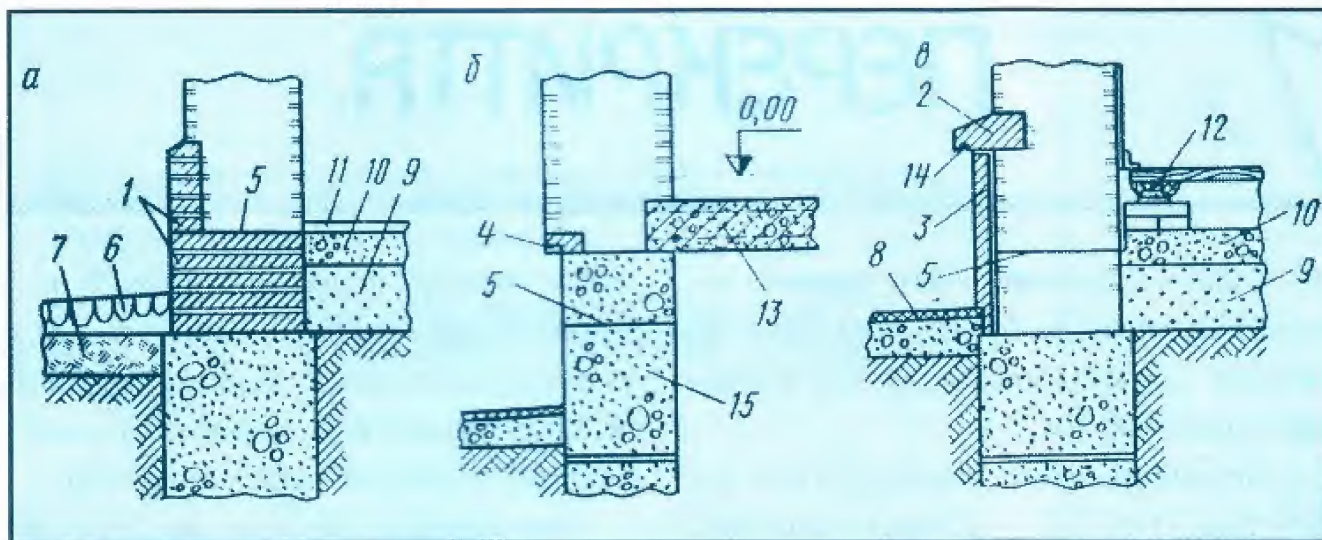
Цоколі цегляних стін: а - облицьовані цеглою; б - цоколь без виступу в будівлі з підвалом; в - облицьований кам'яними плитами; 1 - клінкер; 2 - кордонний камінь; 3 - кам'яні плити; 4 - залізобетонні бруски 75 x 120 мм; 5 - гідроізоляційний шар.
